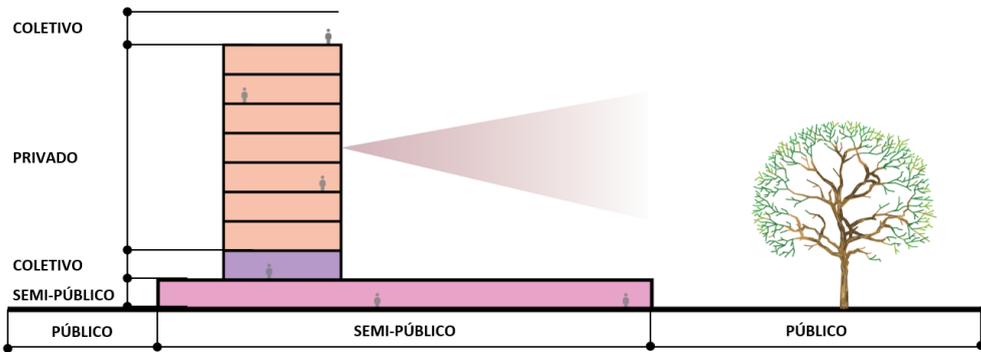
Quadro de croqui do ensaio projetual – 2º ensaio.
